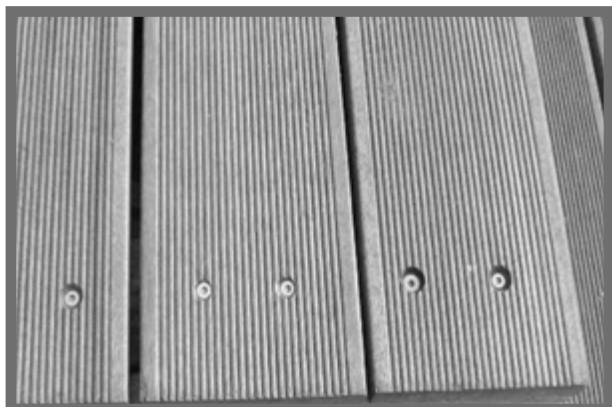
Die Verschraubung hier ist nicht fachgerecht – die Schrauben sind zu tief versenkt worden und der Schraubenabstand ist zu gering bemessen.
